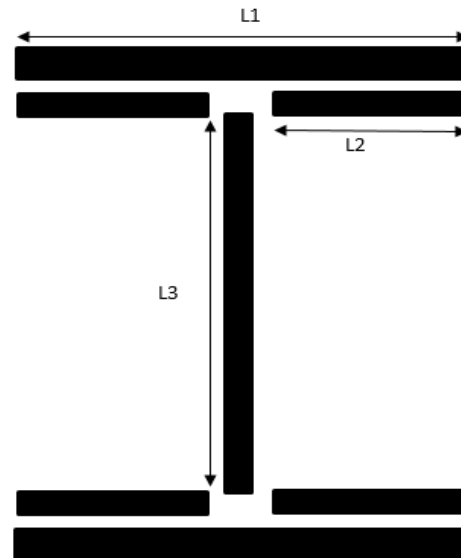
Assemblage soudé poutres –platine
